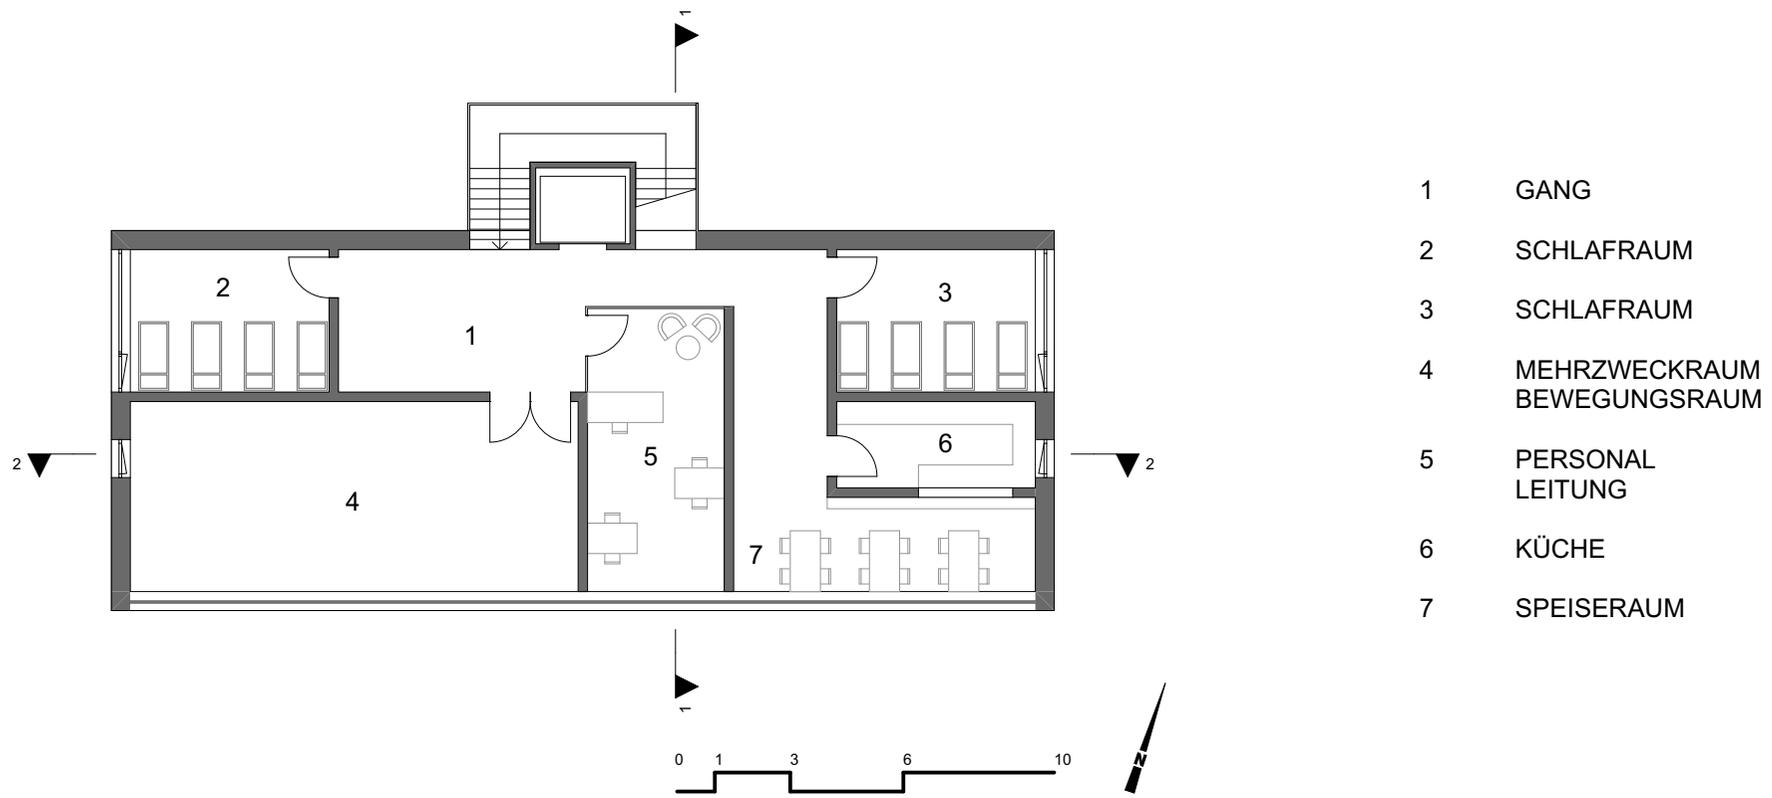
Grundriss Obergeschoss Kindergarten
